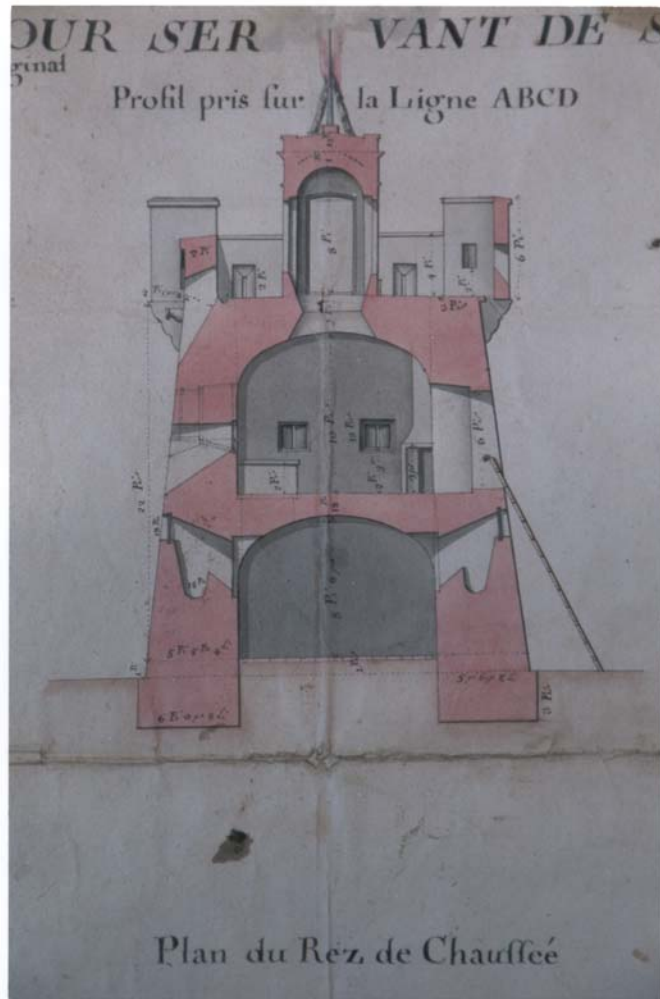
ELEVATION D'UN SIGNAL - 1743
